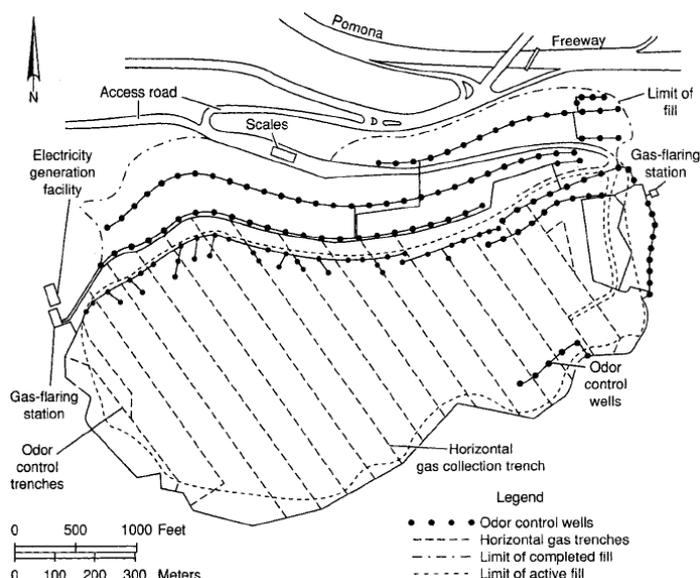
Planta baixa de um sistema de coleta (combinado horizontal e vertical)
